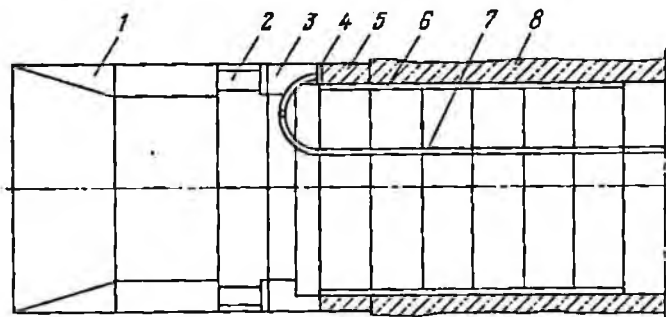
Схема возведения монолитной бетонной крепи методом прессования: 1 — проходческий щит, 2 — дожрат; 3 — прессующее устройство; 4 — заливное устройство, 5 — бетонная смесь, 6 — опалубка; 7 — бетоновод; 8 — бетонная крепь (обделка)
